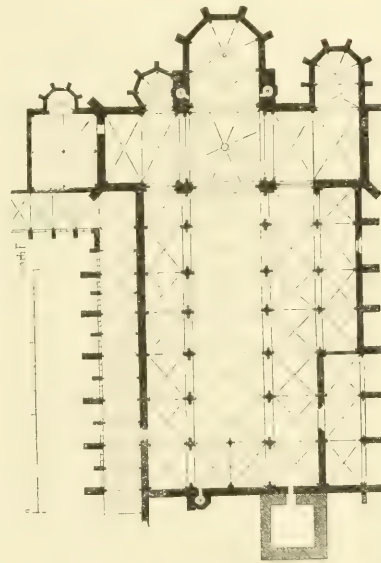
Münster zu Weissenburg. Grundriss.
